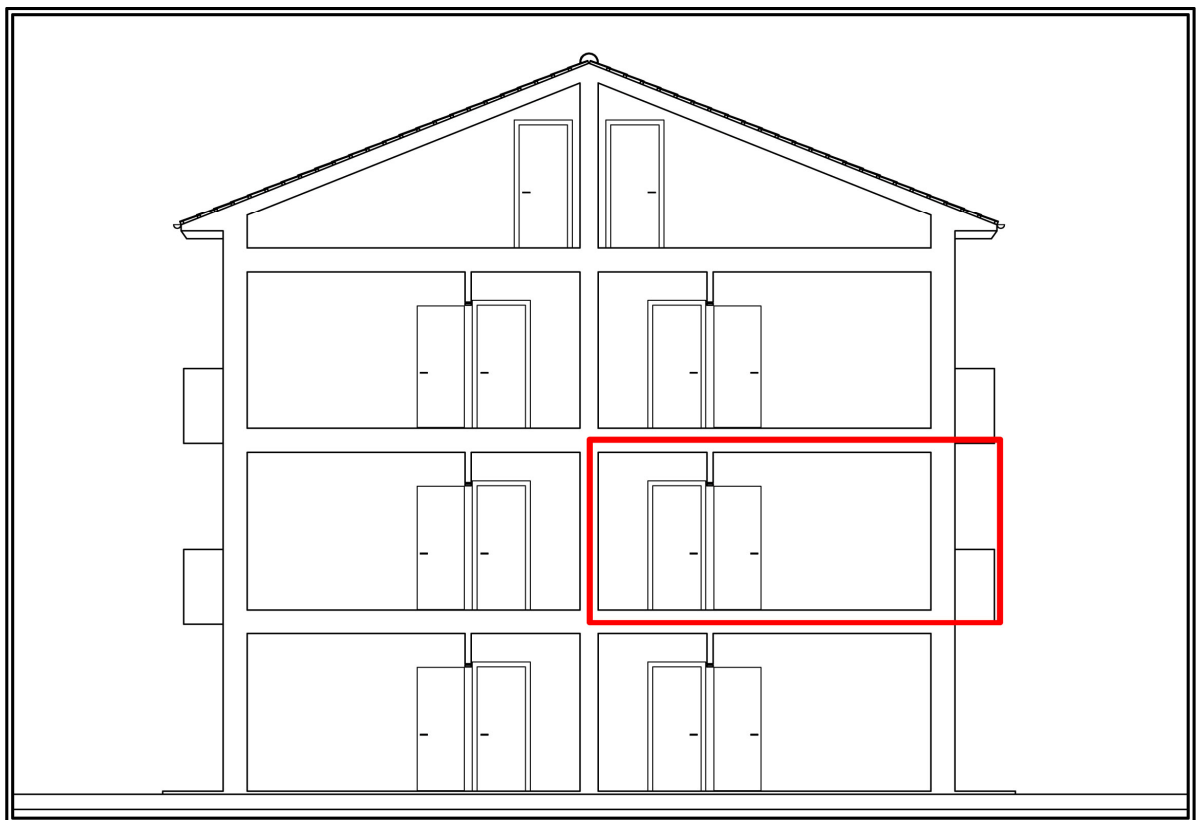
Individuazione in sezione della facciata e della stanza collegata, oggetti dello studio.
